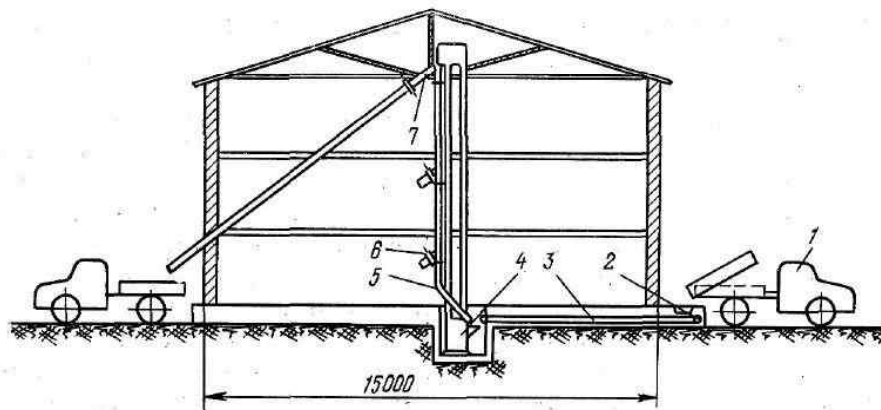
Схема механизированного трехэтажного кормохранилища (ЧССР): 1 — автосамосвал; 2 — приемный бункер; 3 — транспортер ленточный; 4 — норья; 5 — труба-течка; 6 — задвижка; 7 — поворотная головка.
